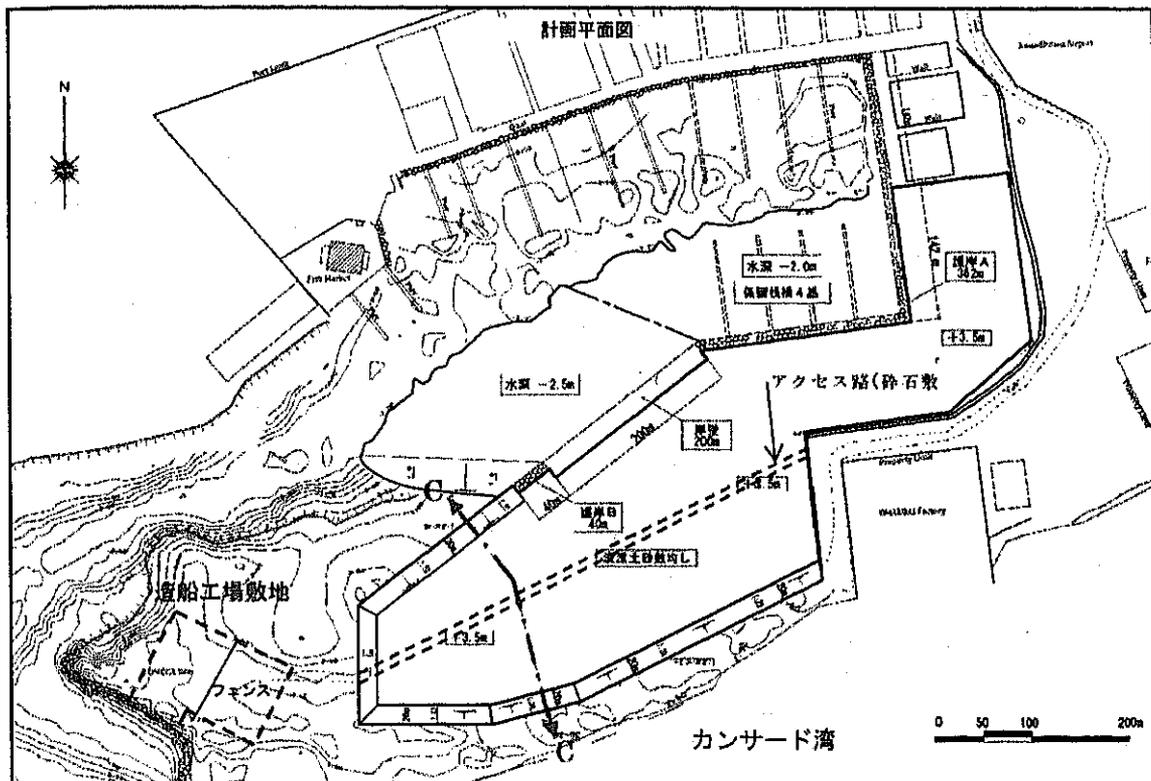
(11) 浚渫土砂の敷き均し計画平面図
